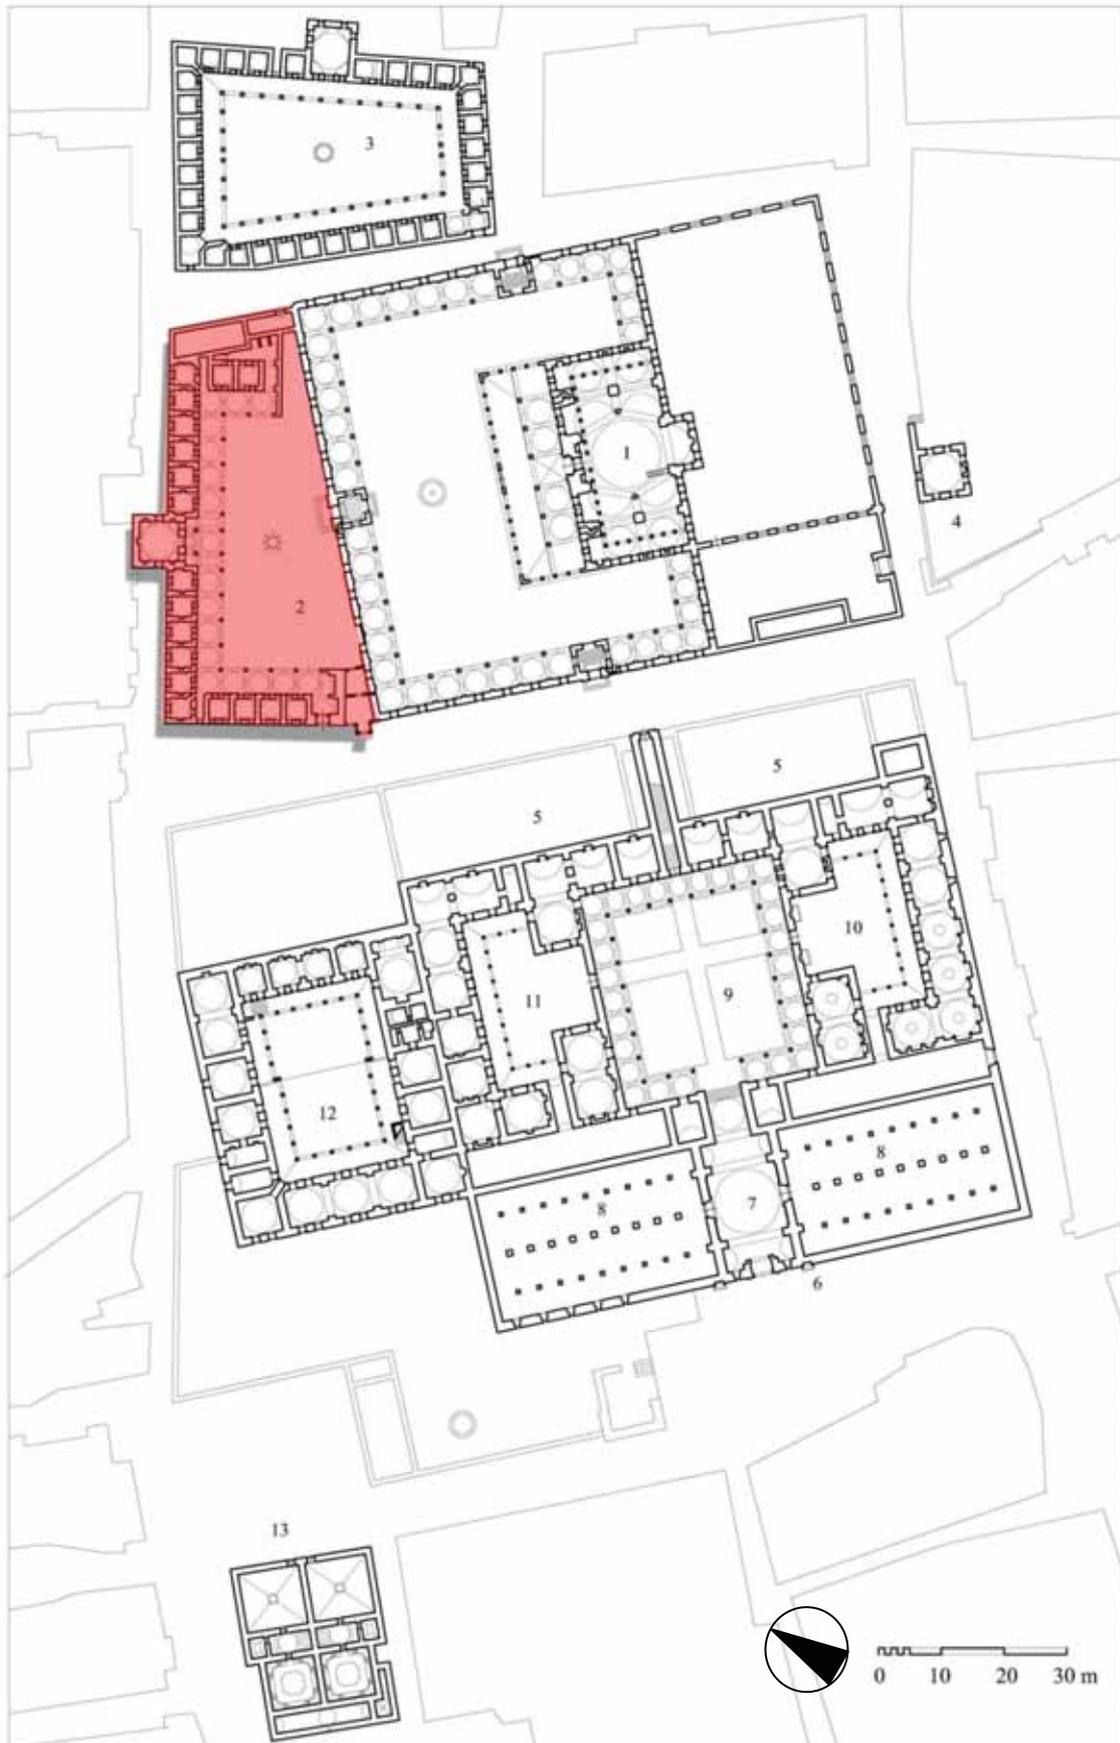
Grundriss und Lageplan der Madrasa
